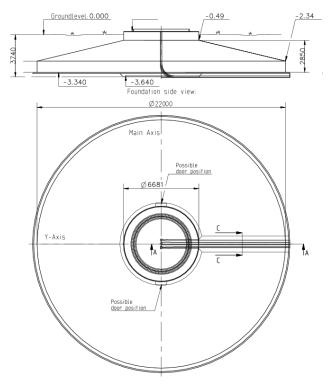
Cimentación propuesta, pendiente de verificar tras estudio geotécnico
